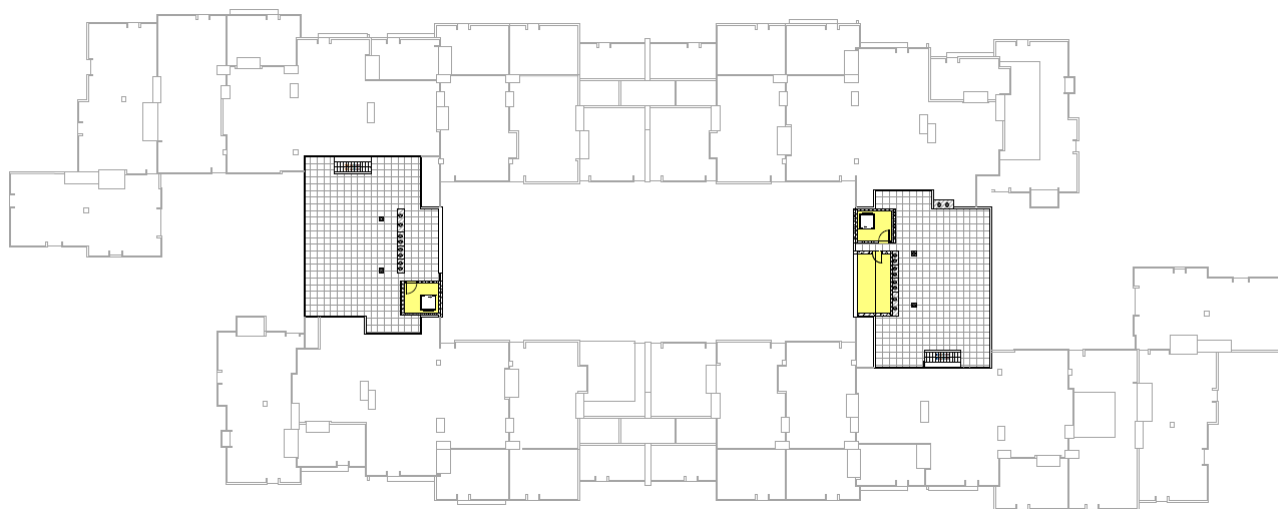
Projektna dokumentacija – shema zona – 4. kat
